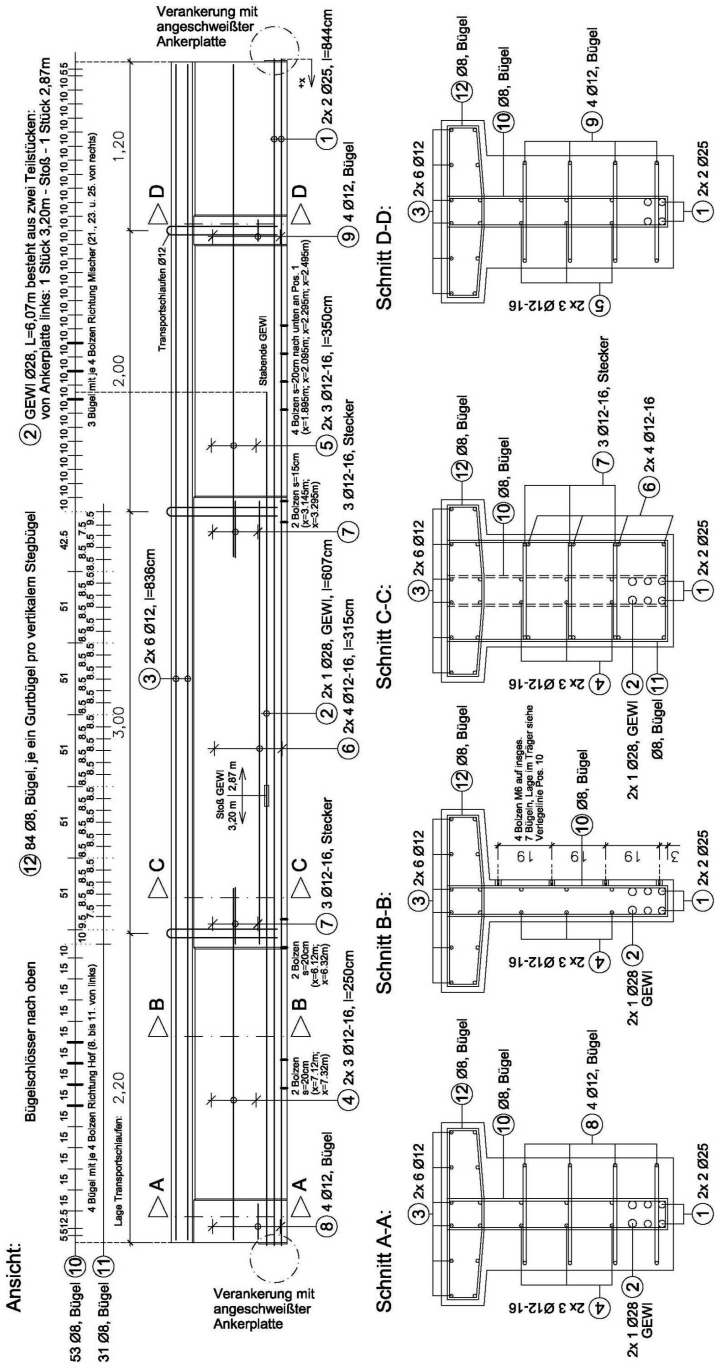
Bewehrungsplan für Träger A, Zeichnung ohne Maßstab.
